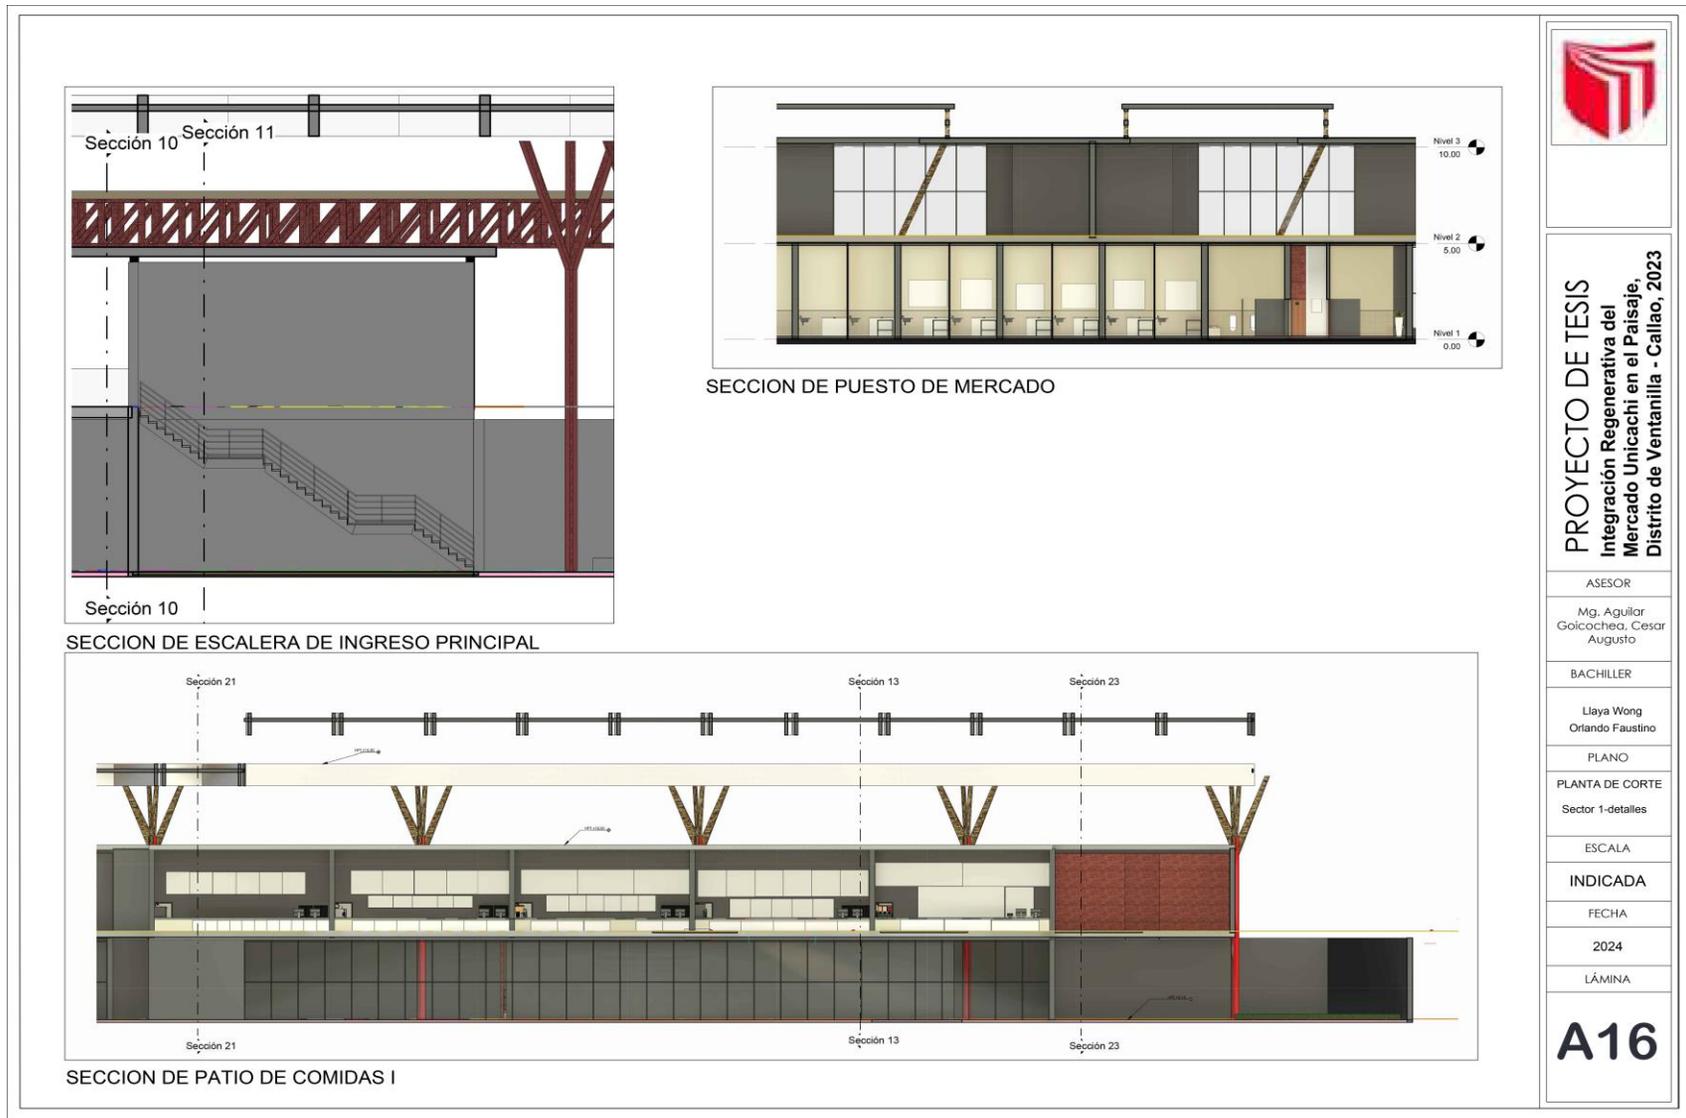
Plano de Cortes elevaciones de sector I – Plano II, elaboración propia.
